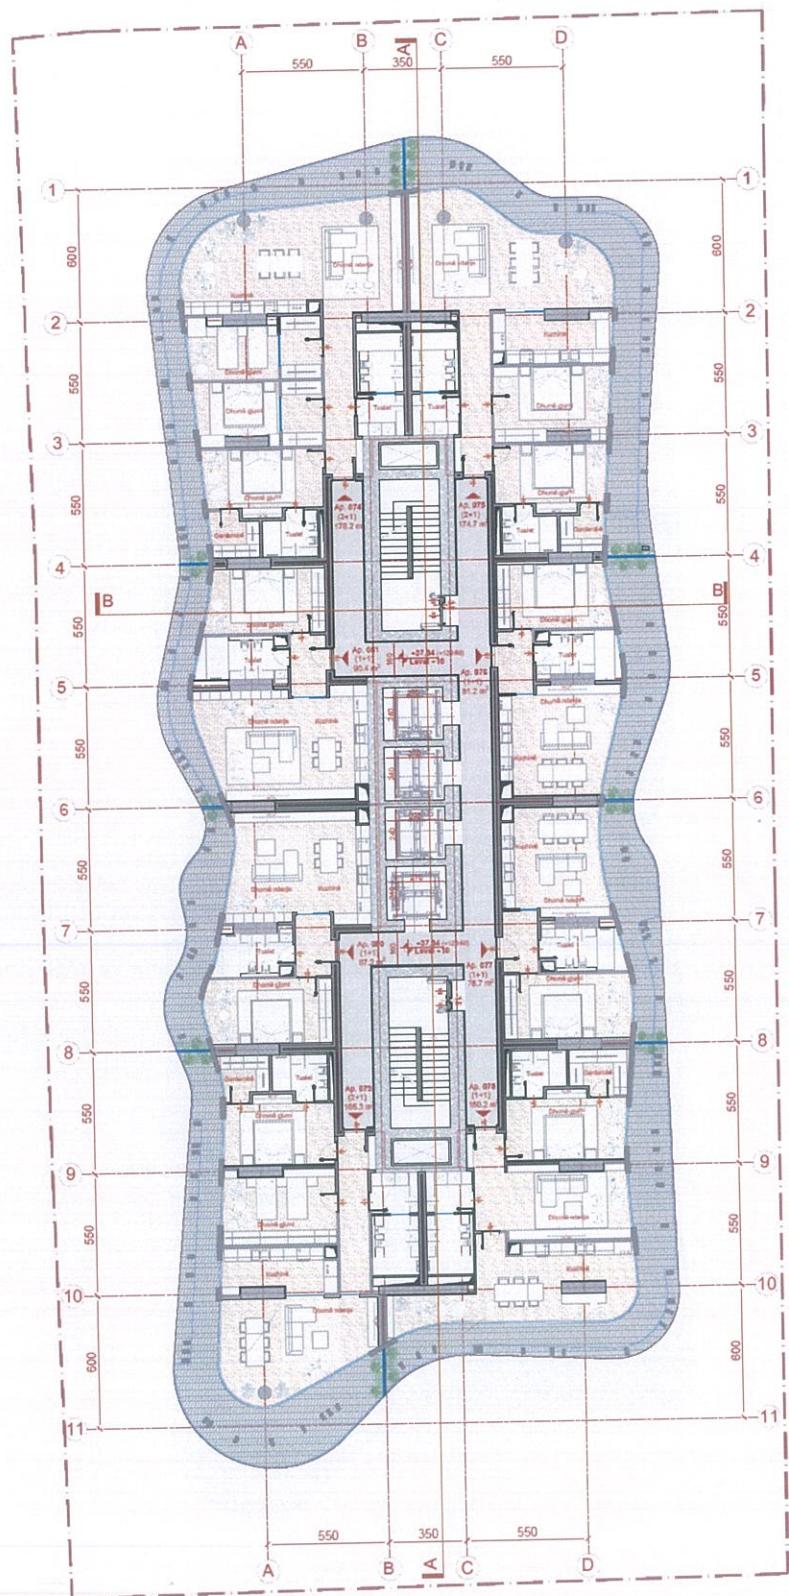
Planimetri i katit të dhjetë (Rezidence).
